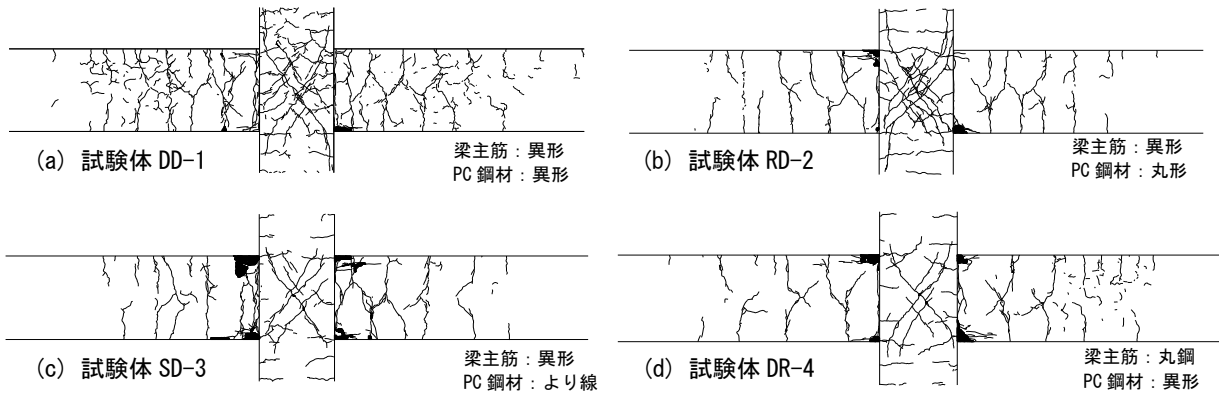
ひび割れ状況（層間変形角 3.0%時）
